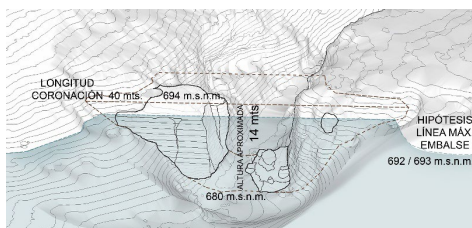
Reconstrucción virtual 3D de la presa de Garganta del Ciervo. Elaboración propia.
